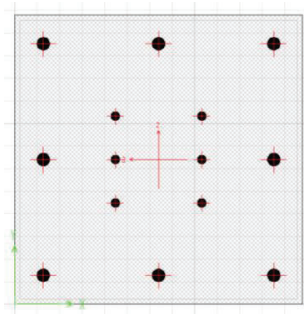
DEFINICIÓN DE LA COLUMNA ENCAMISADA.
